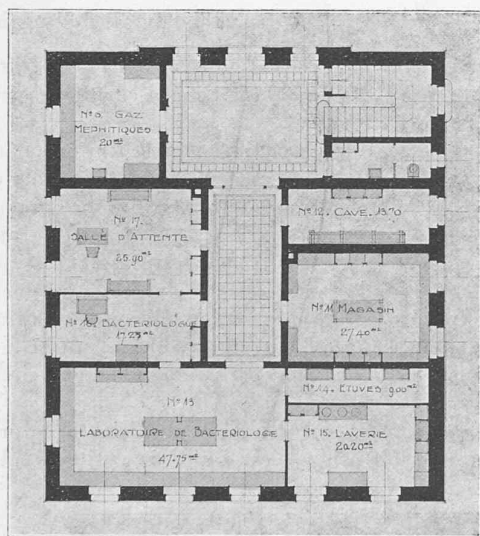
Plan du rez-de-chaussée inférieur. — 1 : 300.
